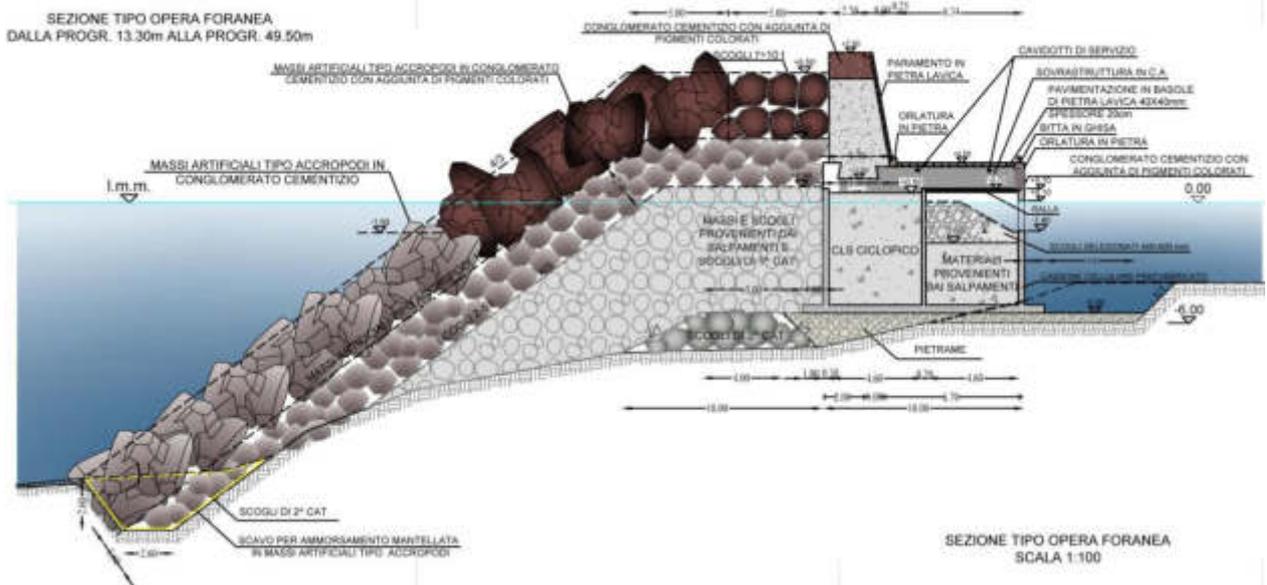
Sezione - Progetto 1° Stralcio funzionale del 2006
